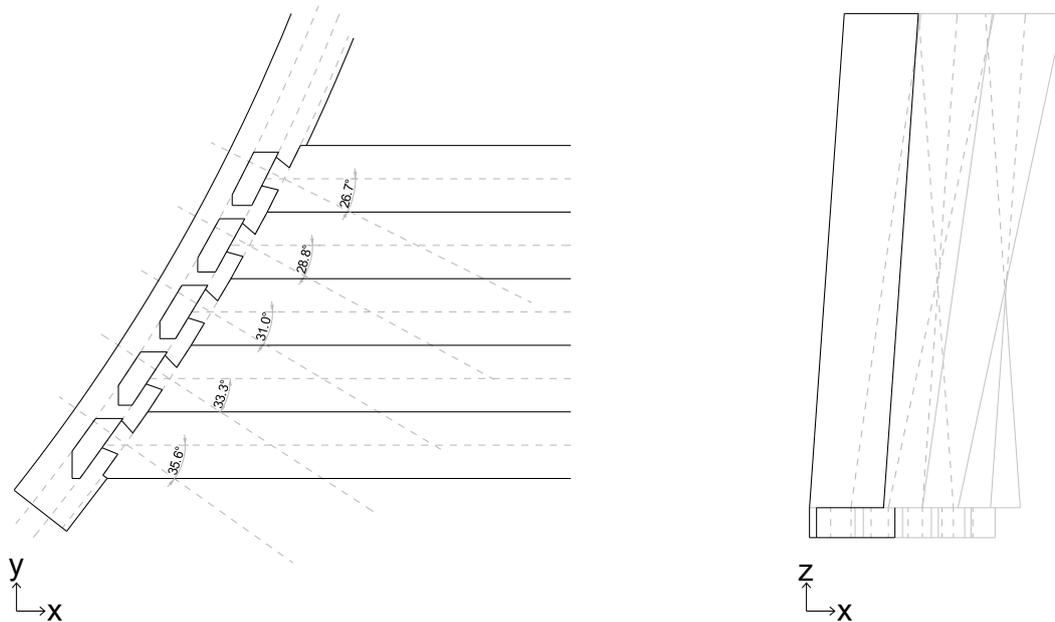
A gauche : Plan de la rencontre entre les poutres de plancher et la poutre de support, avec les axes centraux des poutres et ceux des arondes ; A droite : la variation de l'inclinaison du montant
